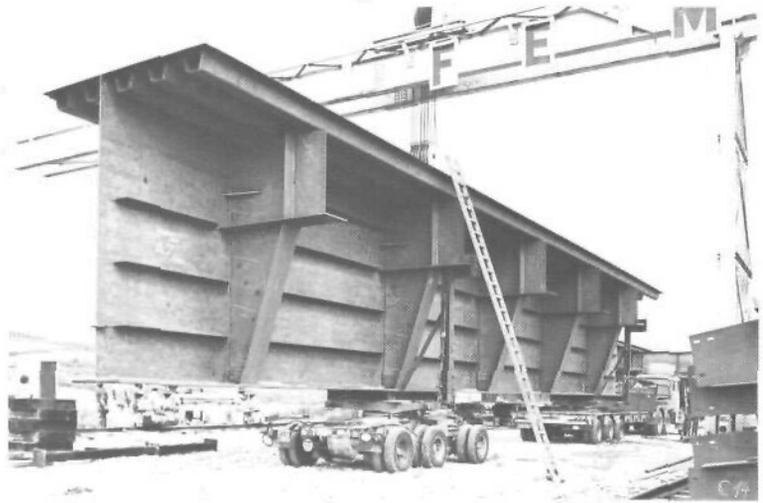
Transport d'un demi-caisson de 25 mètres de longueur pesant 46 tonnes. Un étai provisoire relie le platelage orthotrope et l'entretoise à la membrure inférieure.
